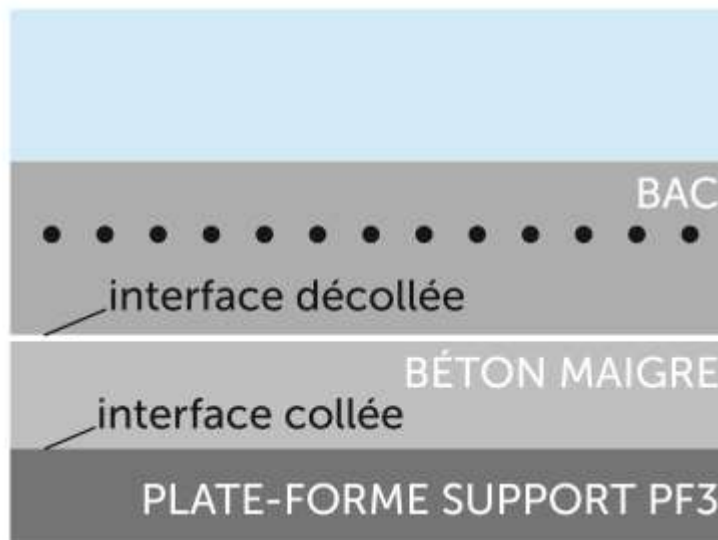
Structure BAC classique (BAC/ Béton maigre) avec collage entre fondation et plate-forme et décollement entre BAC et béton maigre.
